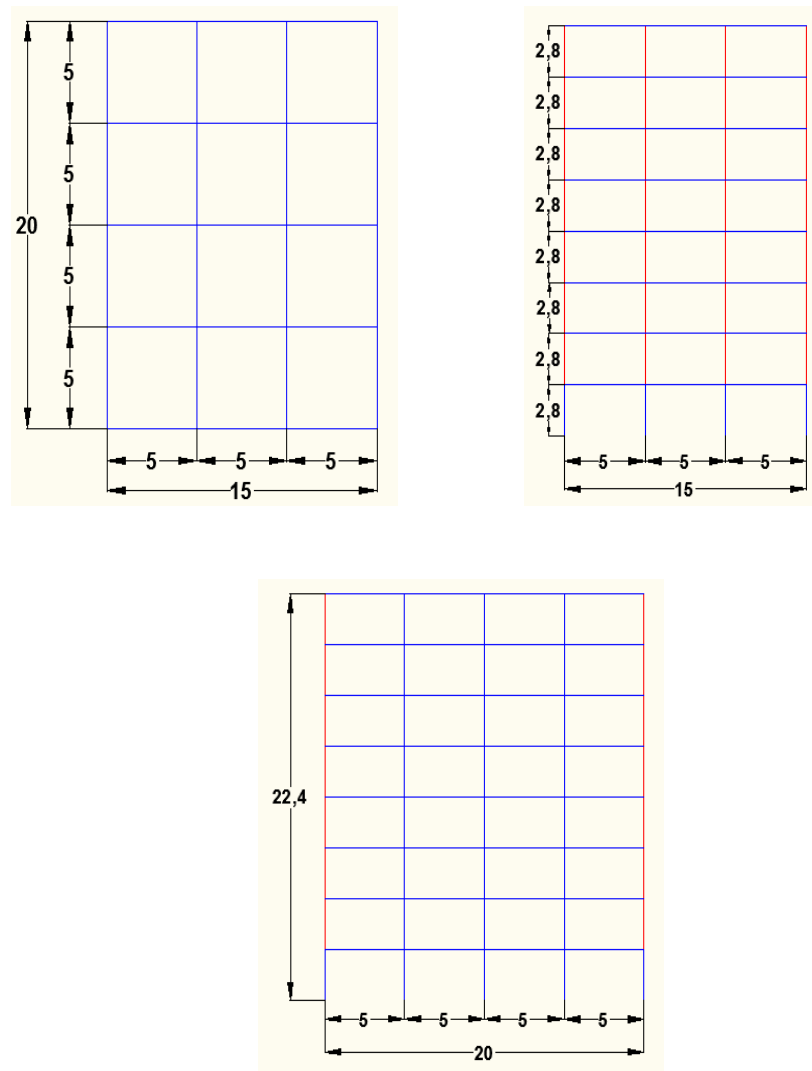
Vistas en: (a) planta, (b) dirección transversal, y (c) dirección longitudinal del edificio. Cotas en metros
